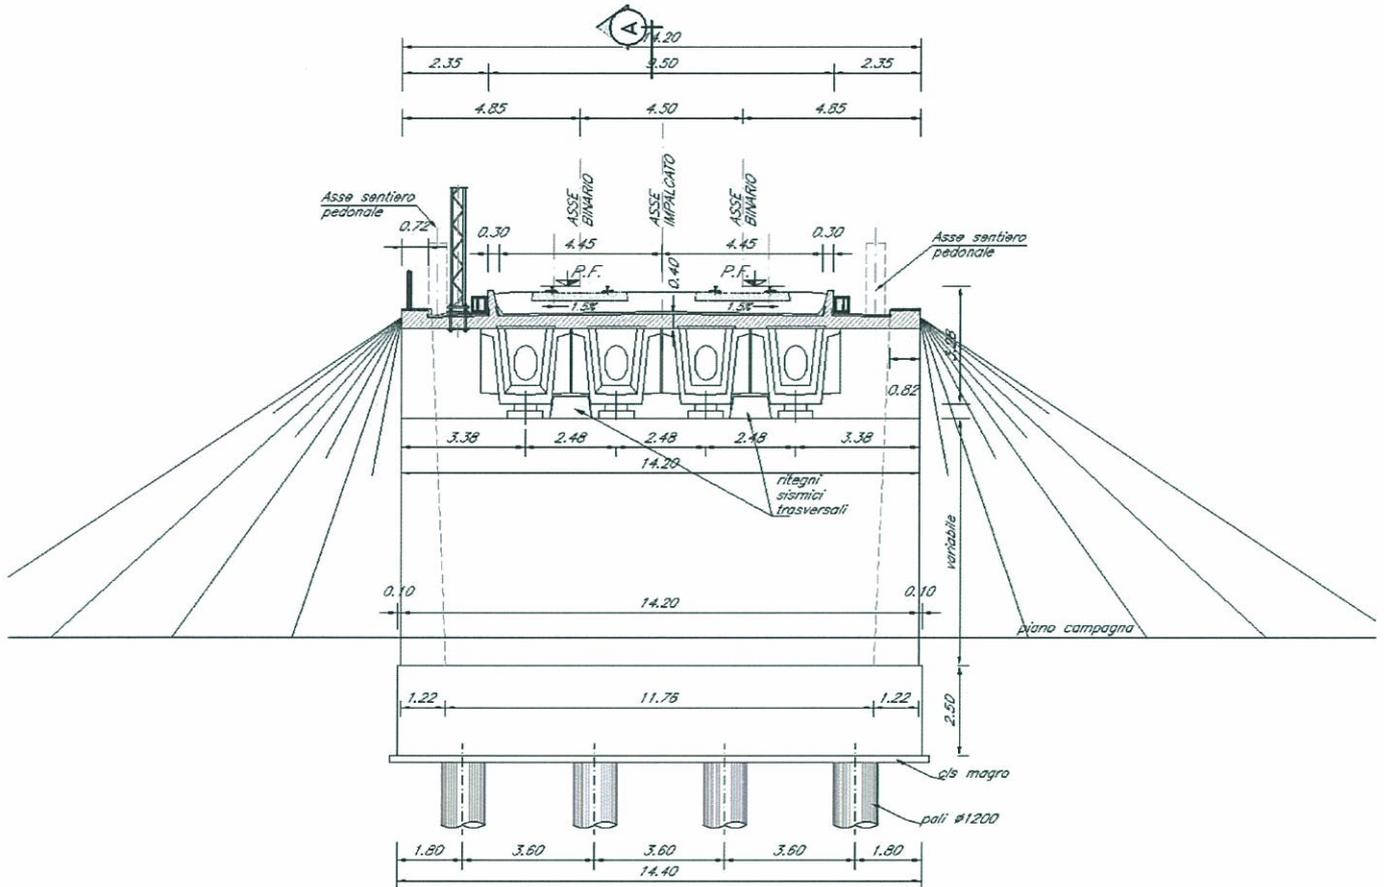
Sezione trasversale in asse appoggi della spalla tipo.
